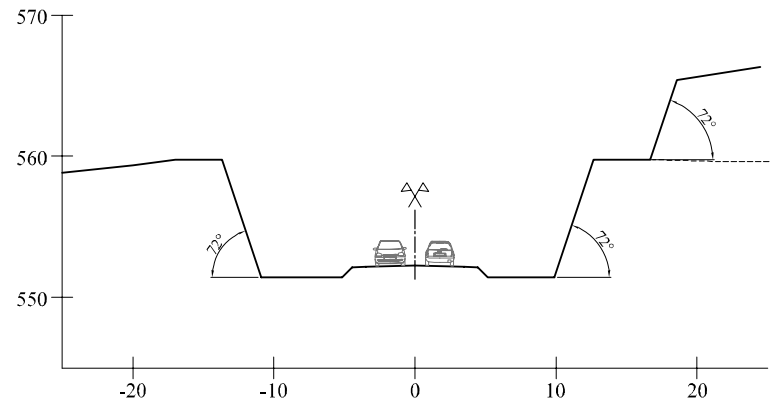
Geometria da seção transversal no 50+840 – planalto.
